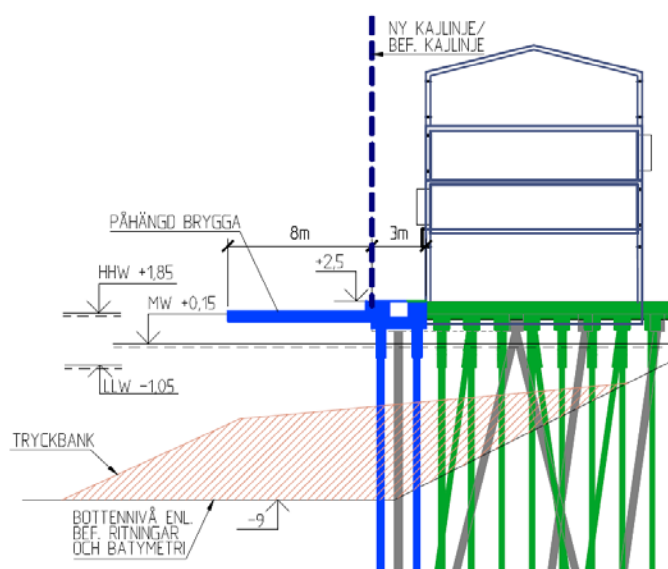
, Planerade tryckbankar samt dess utbredning i plan.
